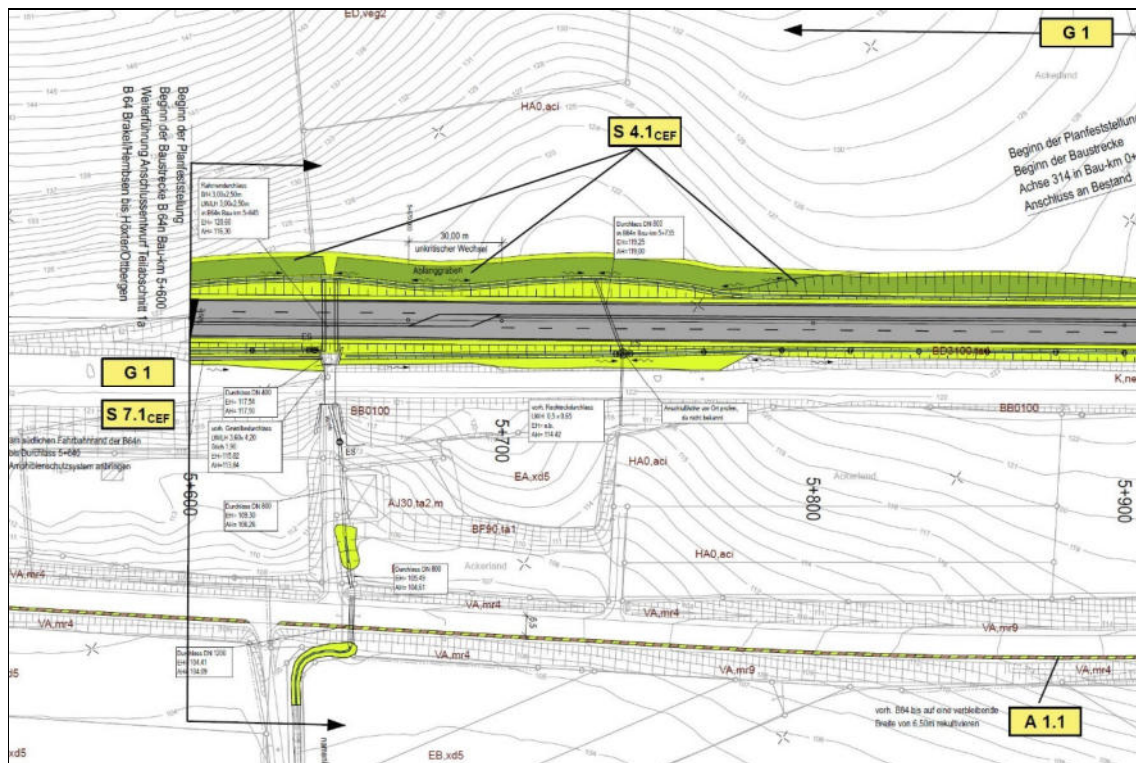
Ausschnitt aus dem Maßnahmenlageplan des LBP zu F 3.
